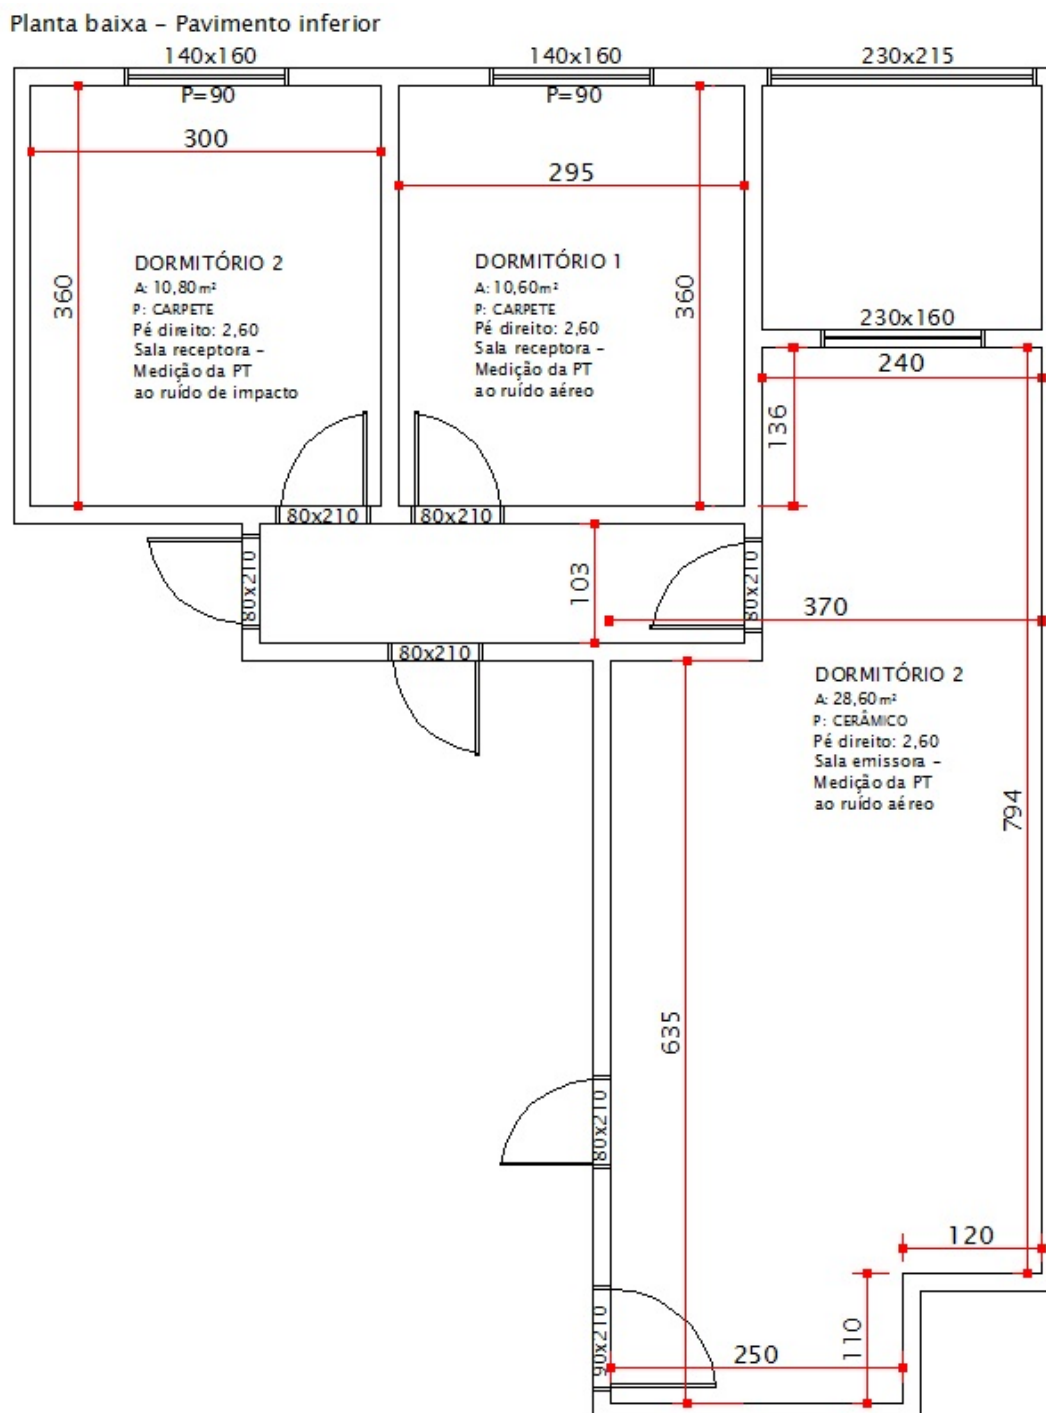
Planta baixa - pavimento inferior - 06-R8-N-TV
